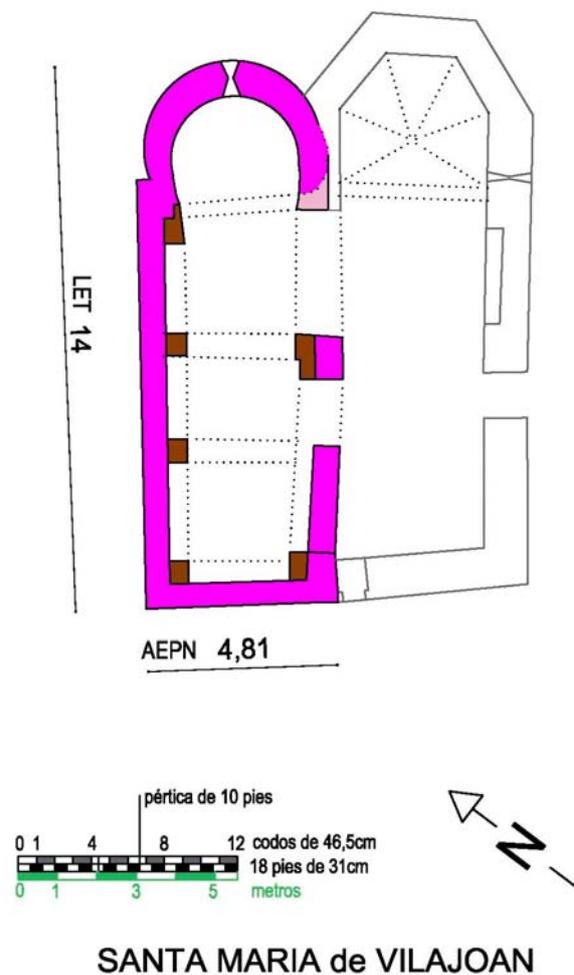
Planta crono-cromática de Sta. María. Elaborada por autora.
